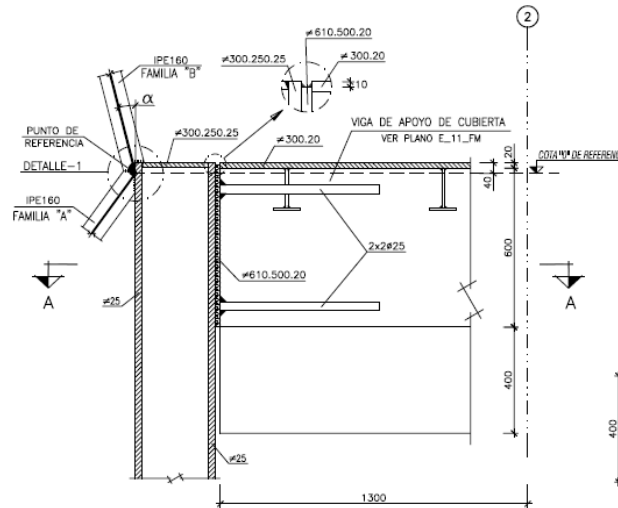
Unión de la viga cajón del mirador con la viga de hormigón armado.
